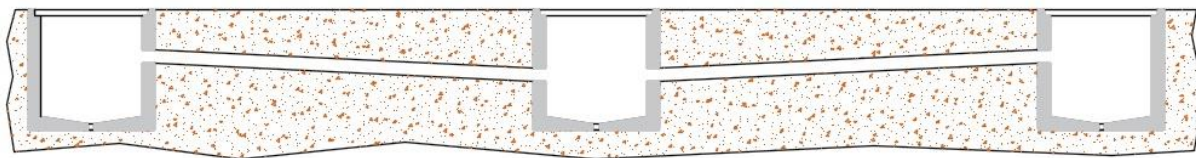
Disposición de pendiente en un sistema de ductos y sistema de drenaje en cajas de revisión
